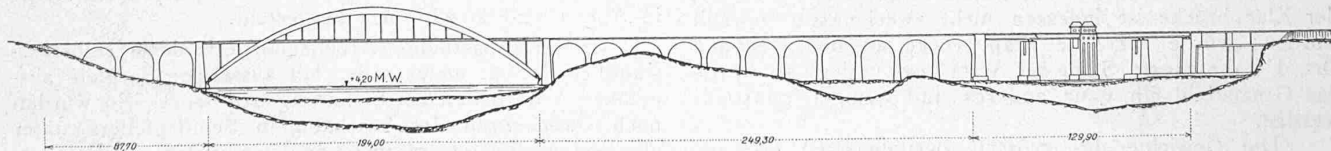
Entwurf „Platbaga“ (Angekauft). — Vollwand-Zweigelenbogen; Eisenbetonviadukt; nördlich Vollwandbalken. — Masstab 1:4000.
